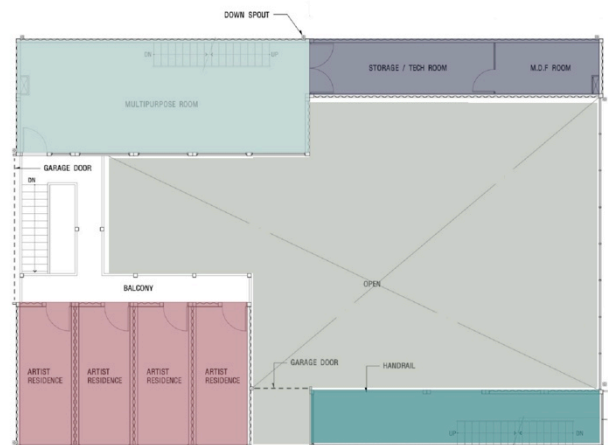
Planta do Piso 1. Platoon Kunsthalle
